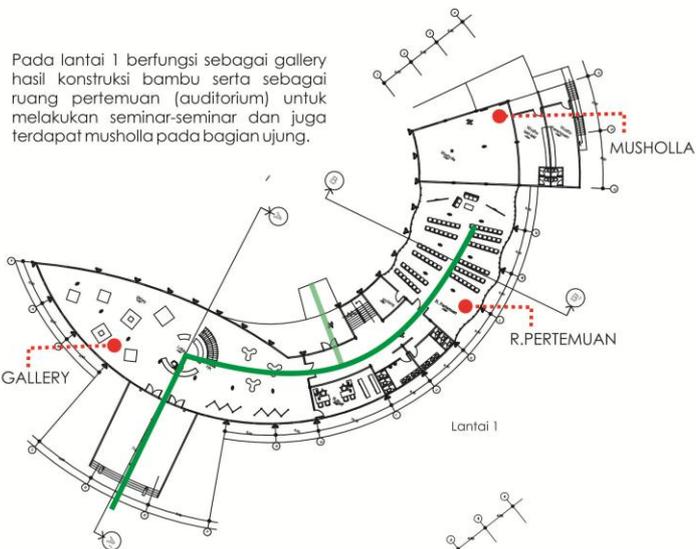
Hasil Rancangan Ruang Dan Bentuk Bangunan
